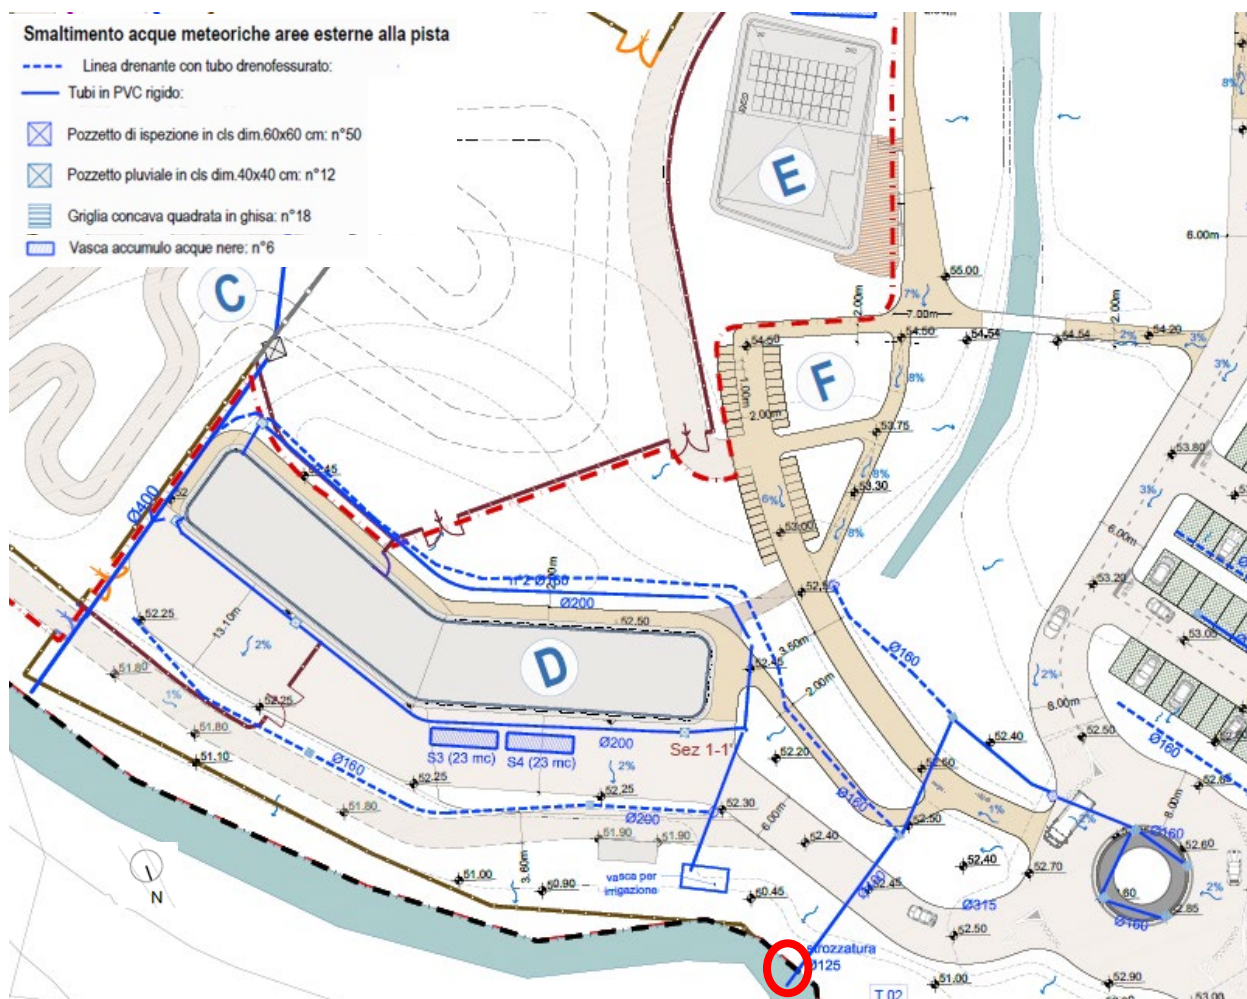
Sistema di drenaggio dell’area occupata dall’edificio FMI e dalla viabilità d’ingresso
